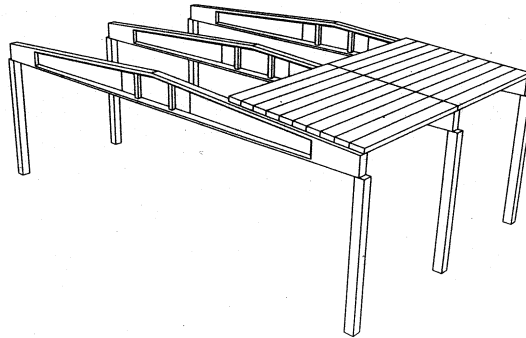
Portiekconstructie met dakelementen in cellenbeton of in voorgespannen holle elementen
